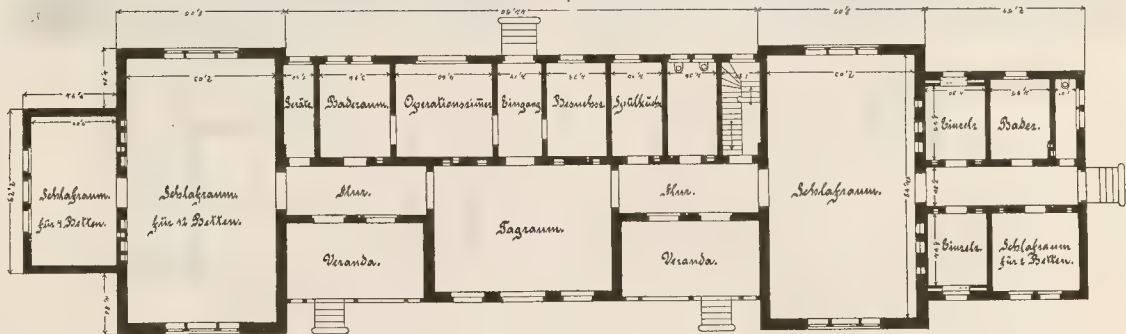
Gebäude 1 und 2; Grundriss.
